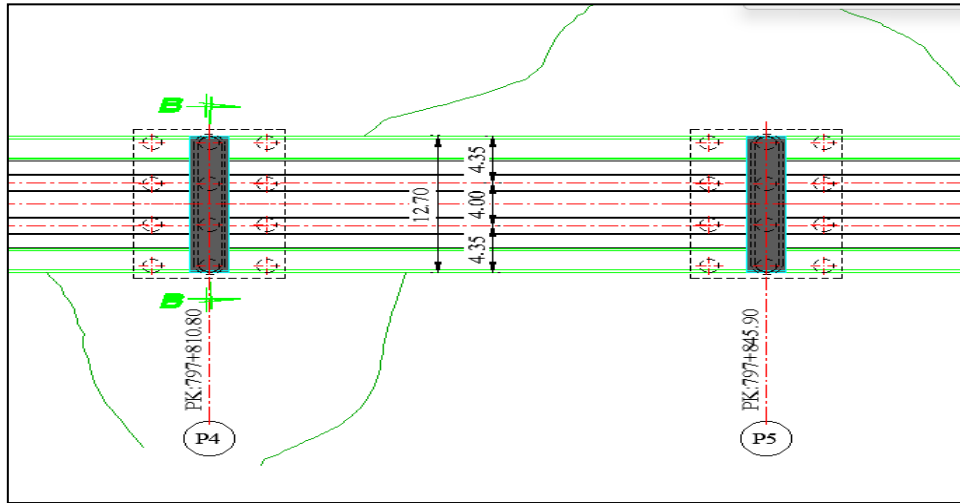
La Vue en plan de Viaduc 797+780 AU PK 798+165
